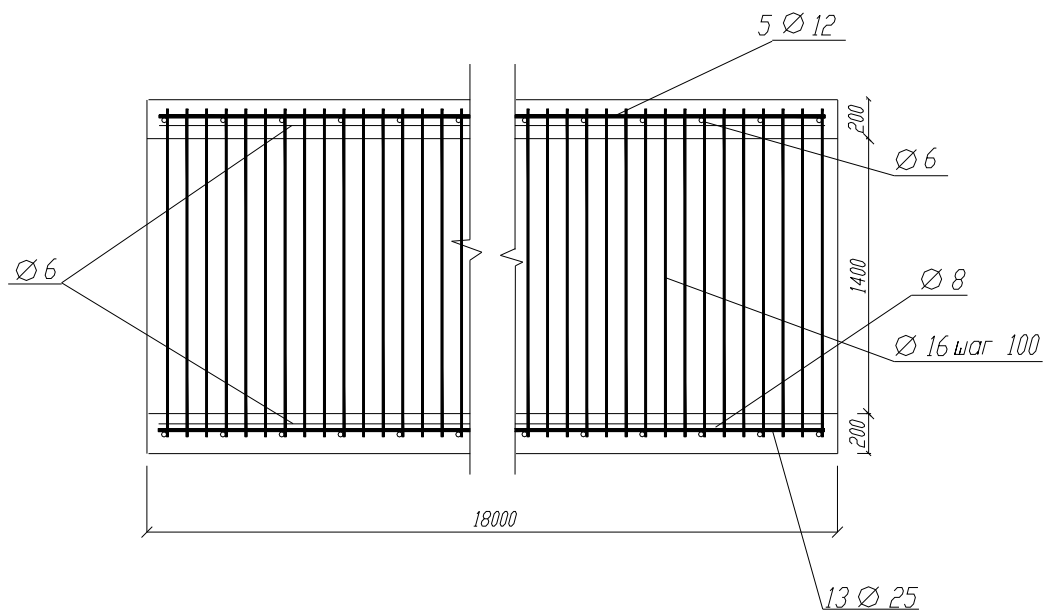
Схема армування фундаменту на ділянці між осями Г-Ж
